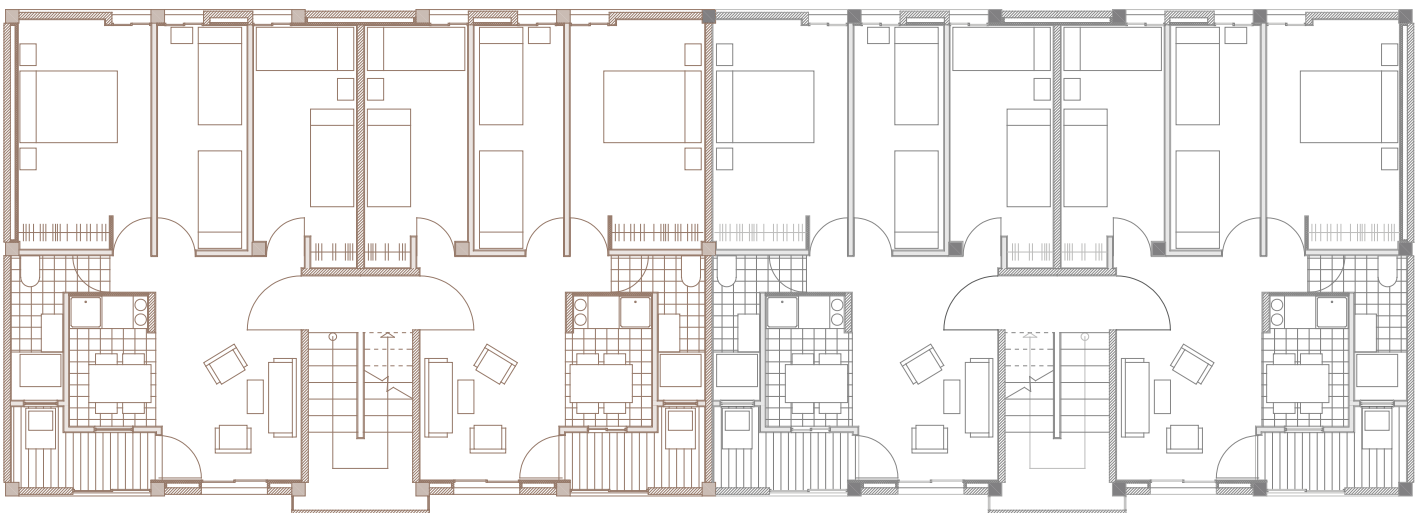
Planimetría Planta Tipo Bloque caso de estudio y bloque anexo
